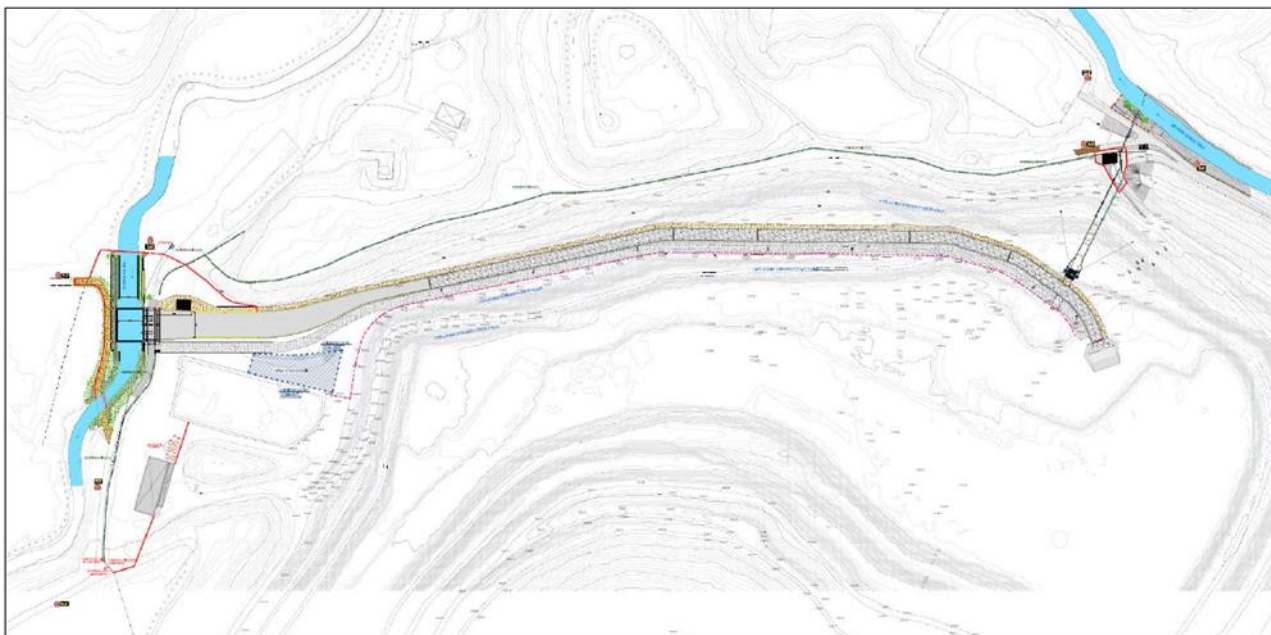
Planimetria di progetto dell'area di laminazione prevista nella Cava di Brenno
